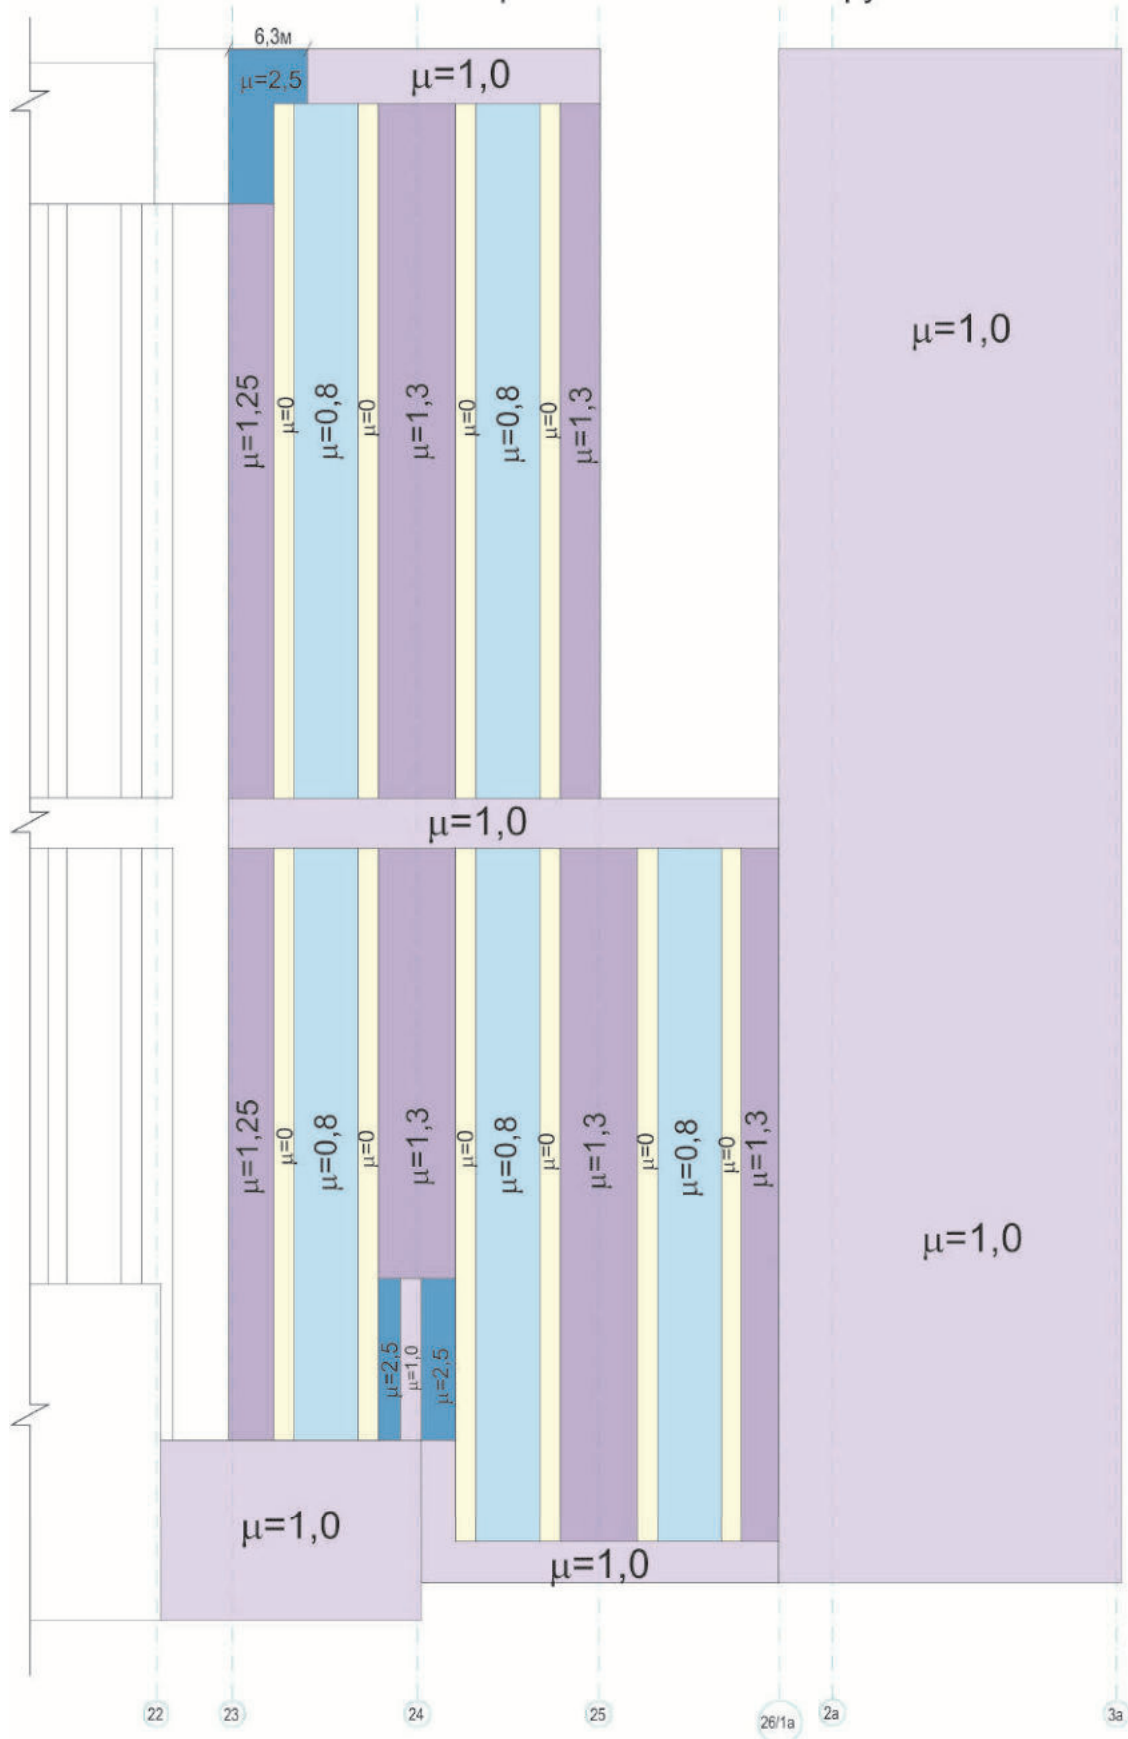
2-ой вариант покрытия. Снеговые нагрузки. Вариант 1
